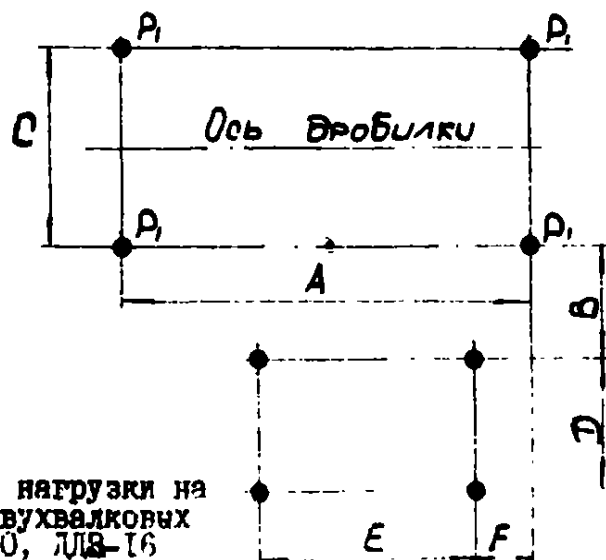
Схема распределения нагрузки на опоры от дробилок двухвалковых зубчатых типа ДЦЗ-10, ДЦЗ-16
